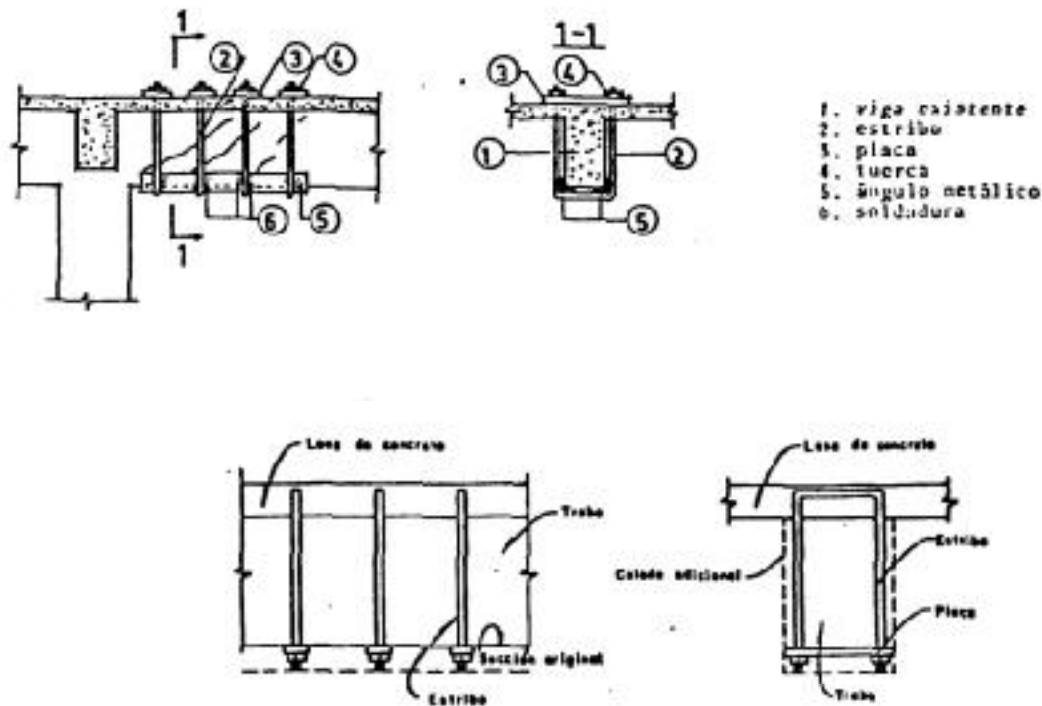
Refuerzo de vigas con estribos postensados (refs. 1 y 2)
